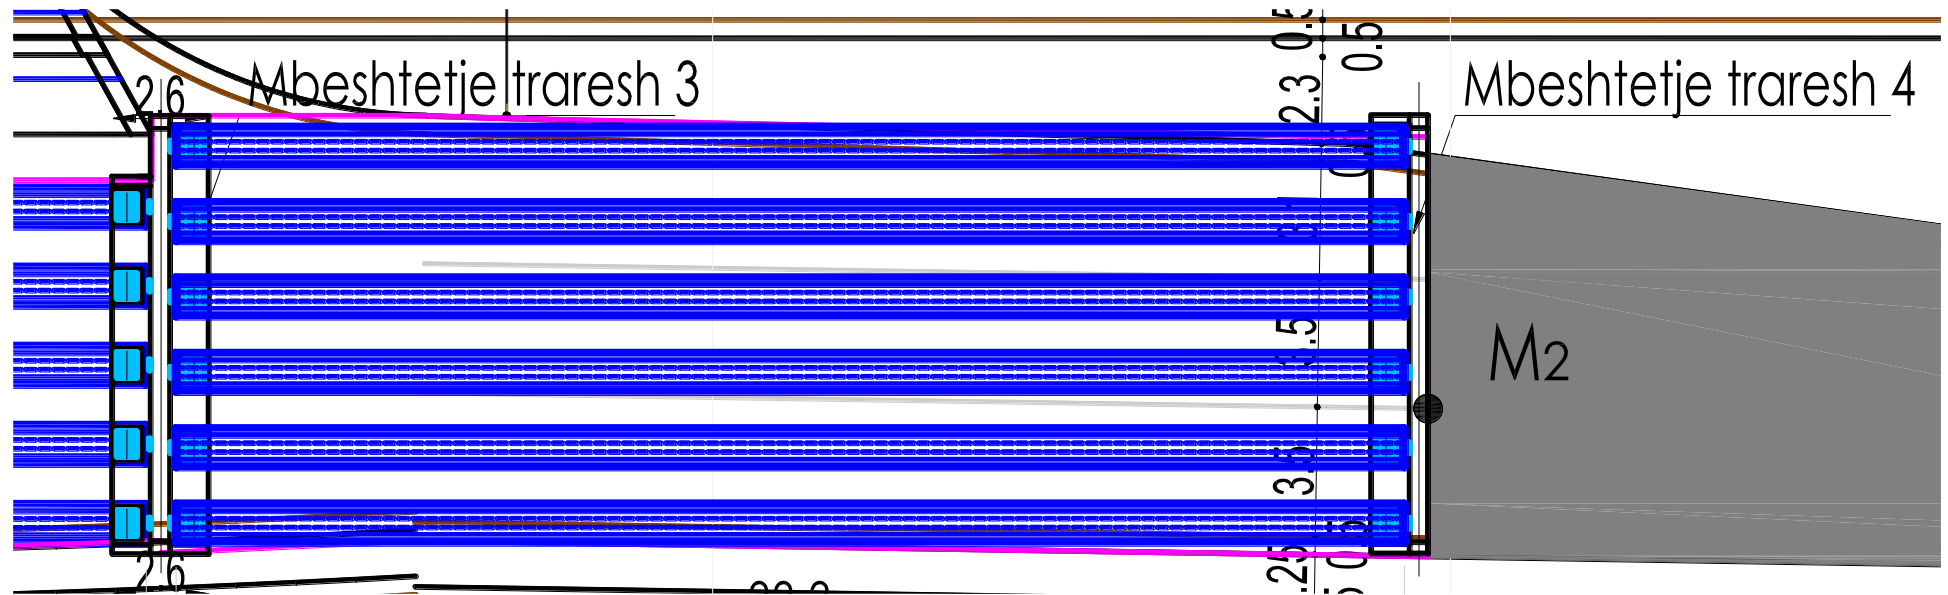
Pjesë planimetrie - Strukturat e LOT 3 - Struktura M2
